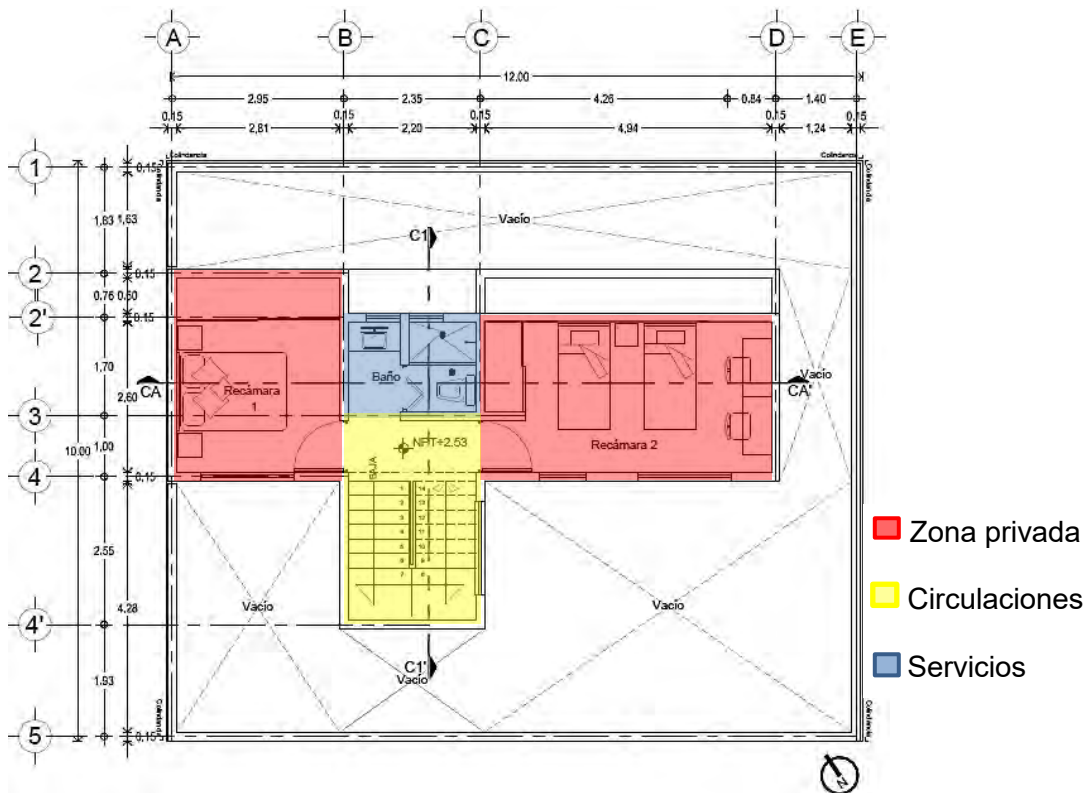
Planta arquitectónica de prototipo de vivienda C2. Segunda etapa, planta alta.
